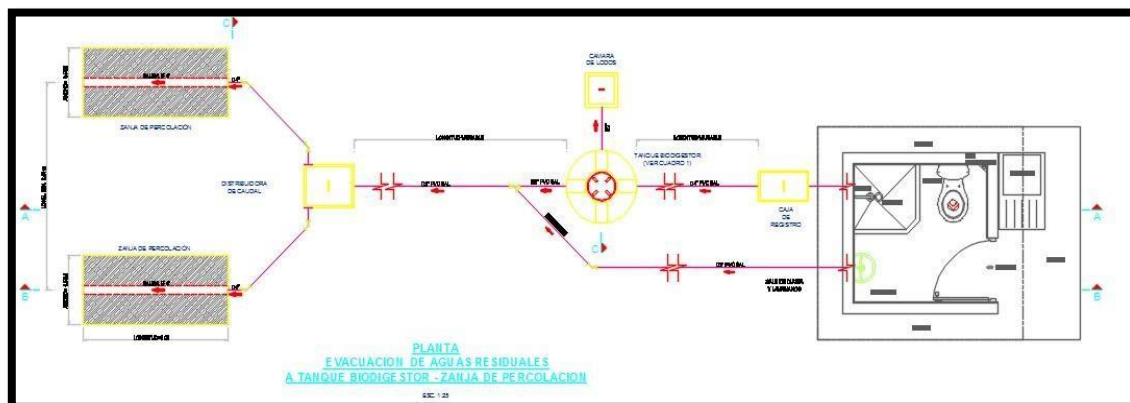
VISTA EN PLANTA DE ZANJA DE INFILTRACION
